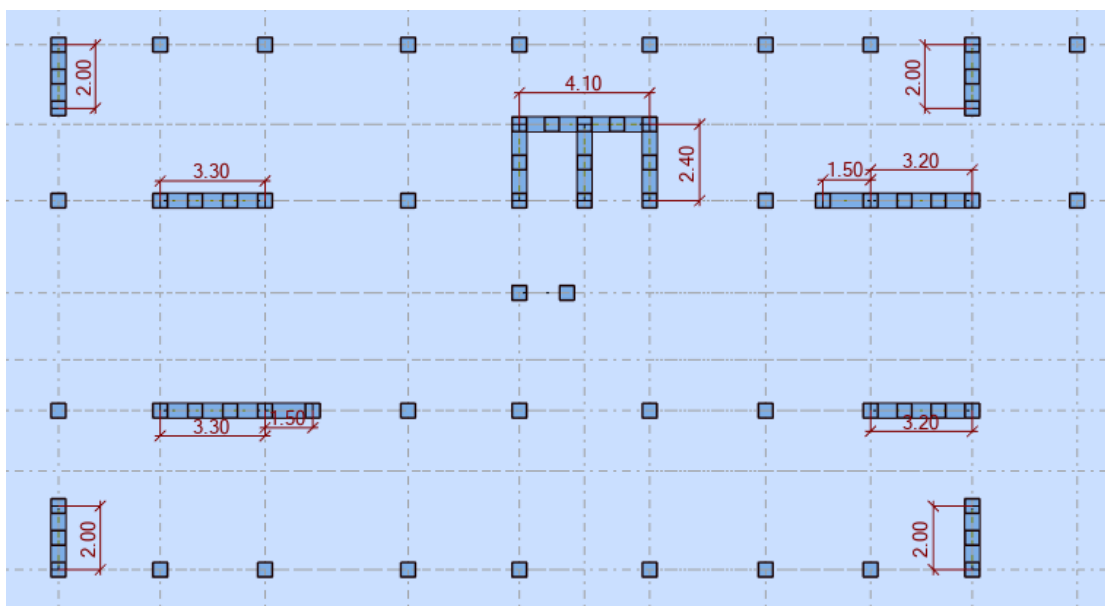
Disposition des voiles de contreventement vue en plan.
